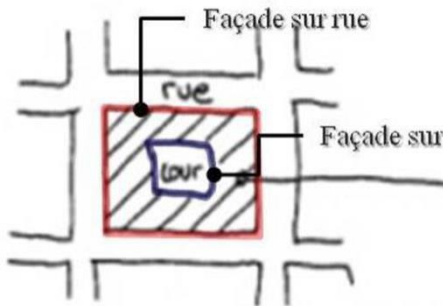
Plan d'un îlot haussmannien, J.J.Deluz
